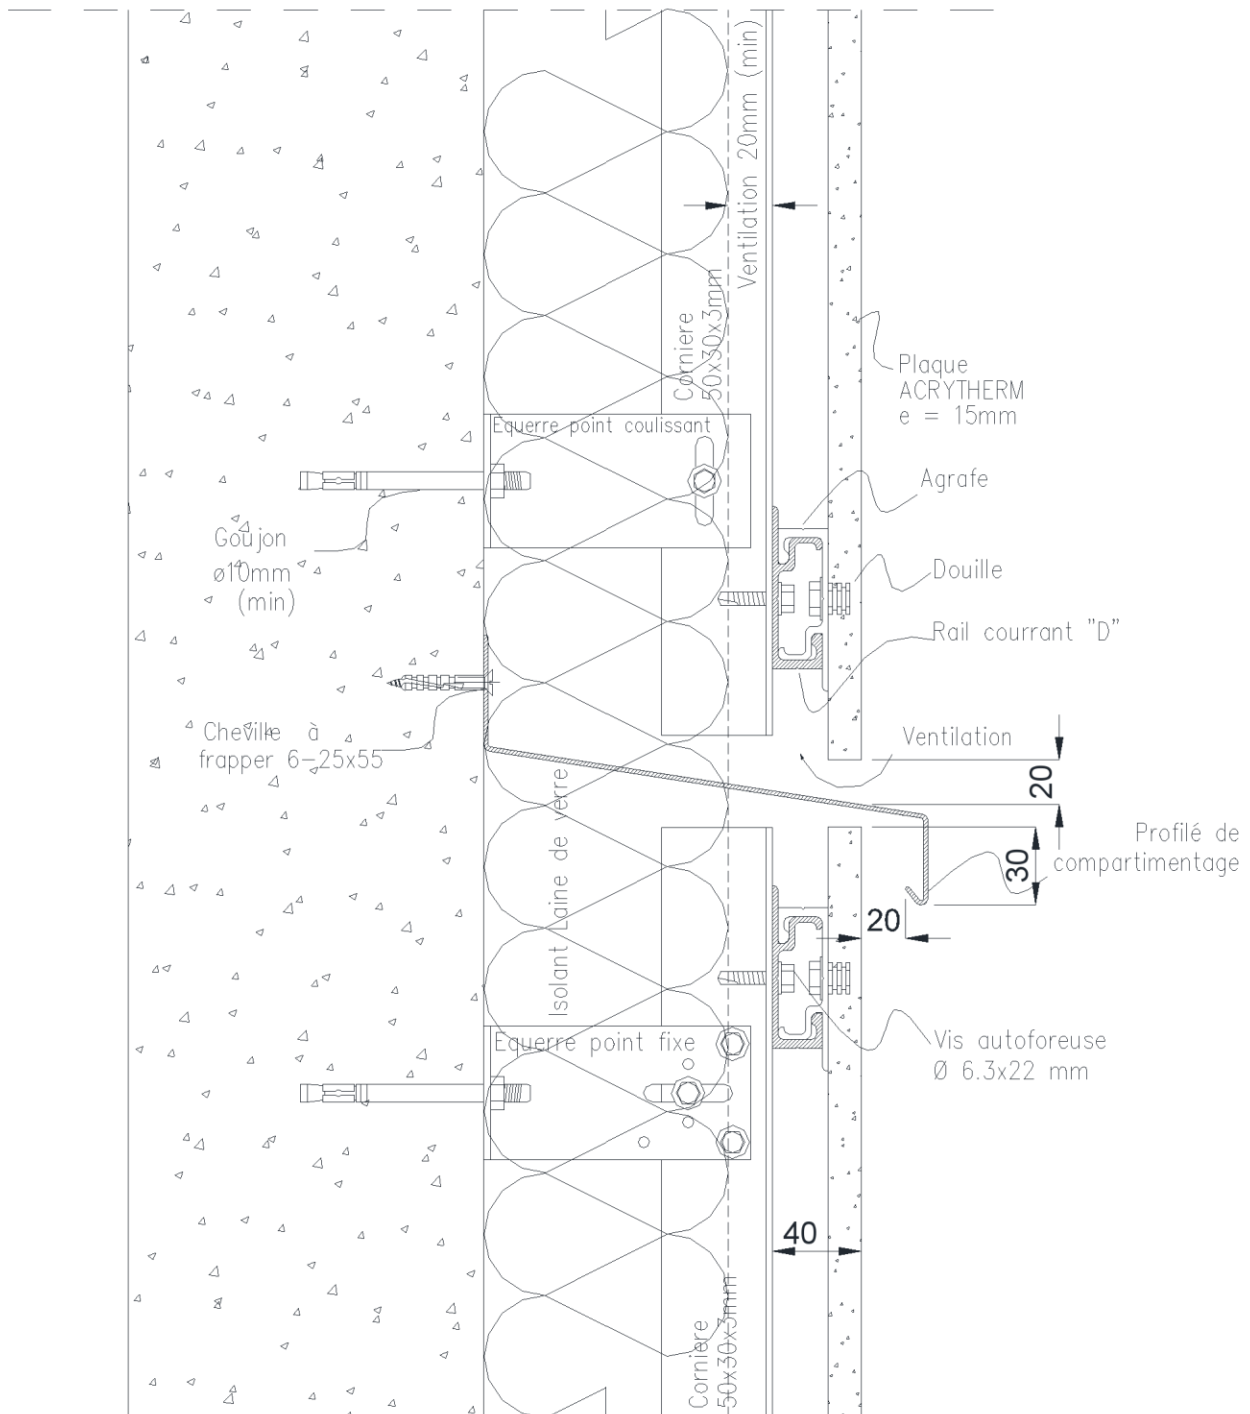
Coupe verticale joint de fractionnement de la lame d'air
